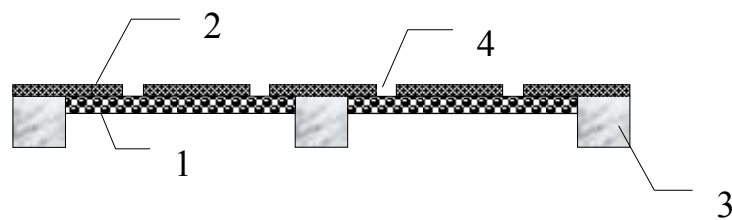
Схема верхнего полимербетонного дренажа 1 – полимербетонная плита; 2 – пластмассовая плита; 3 – опора; 4 – отверстие.
